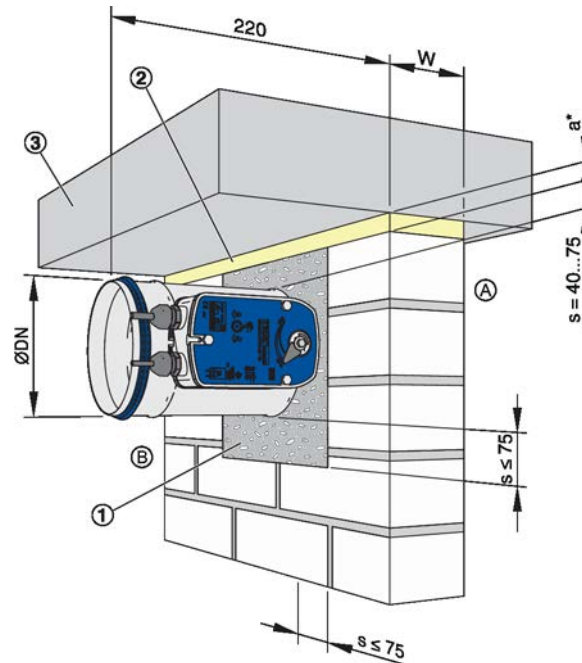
Nasseinbau in Massivwand mit gleitendem Deckenanschluss
